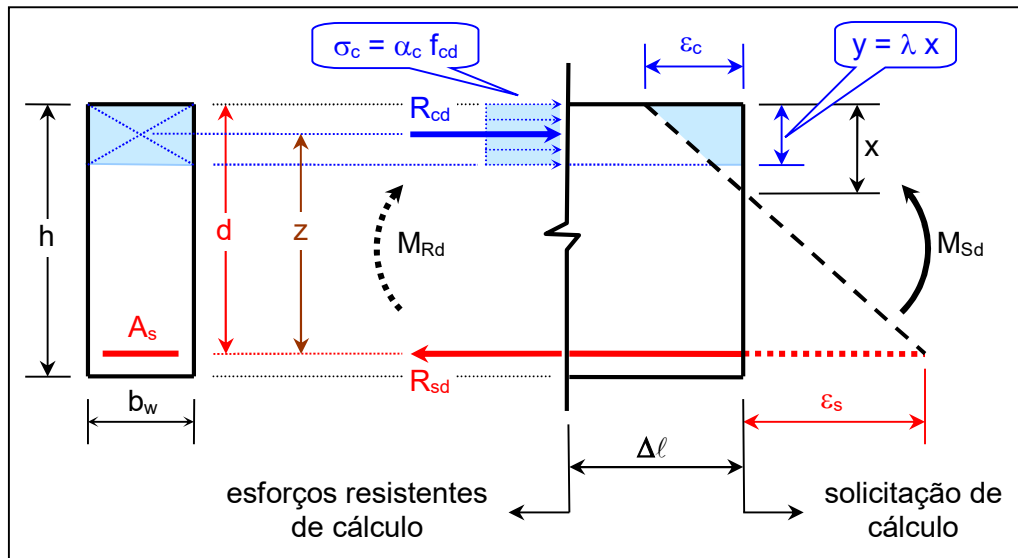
Viga de seção retangular sem armadura de compressão
